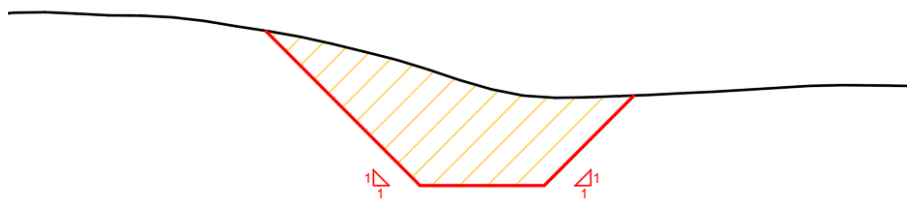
Opera 4 - Estratto Tav. PFTE.17 - Sezione Tipologica
